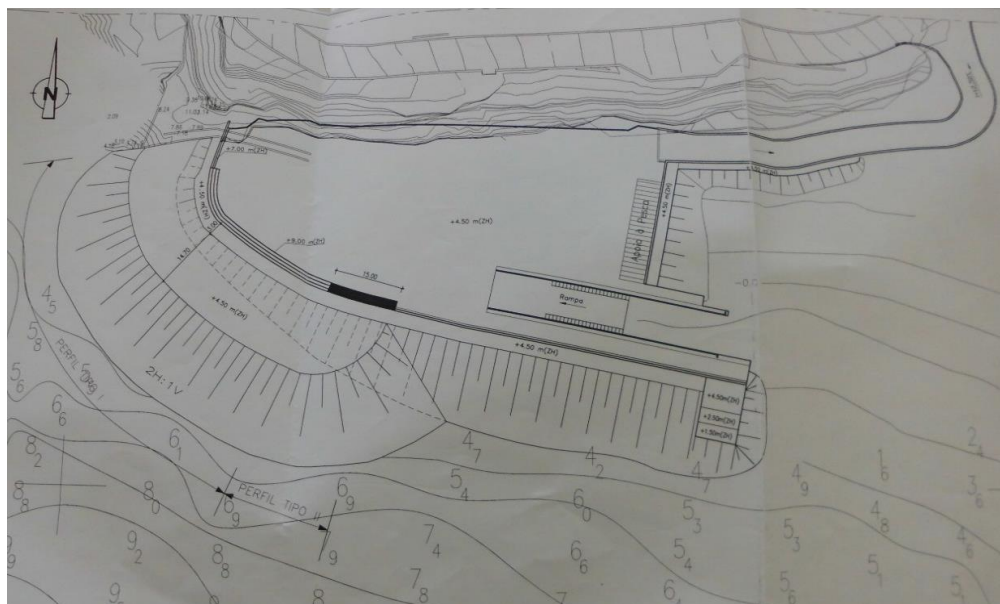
Planta geral do estaleiro de reparação naval de Câmara de Lobos.
